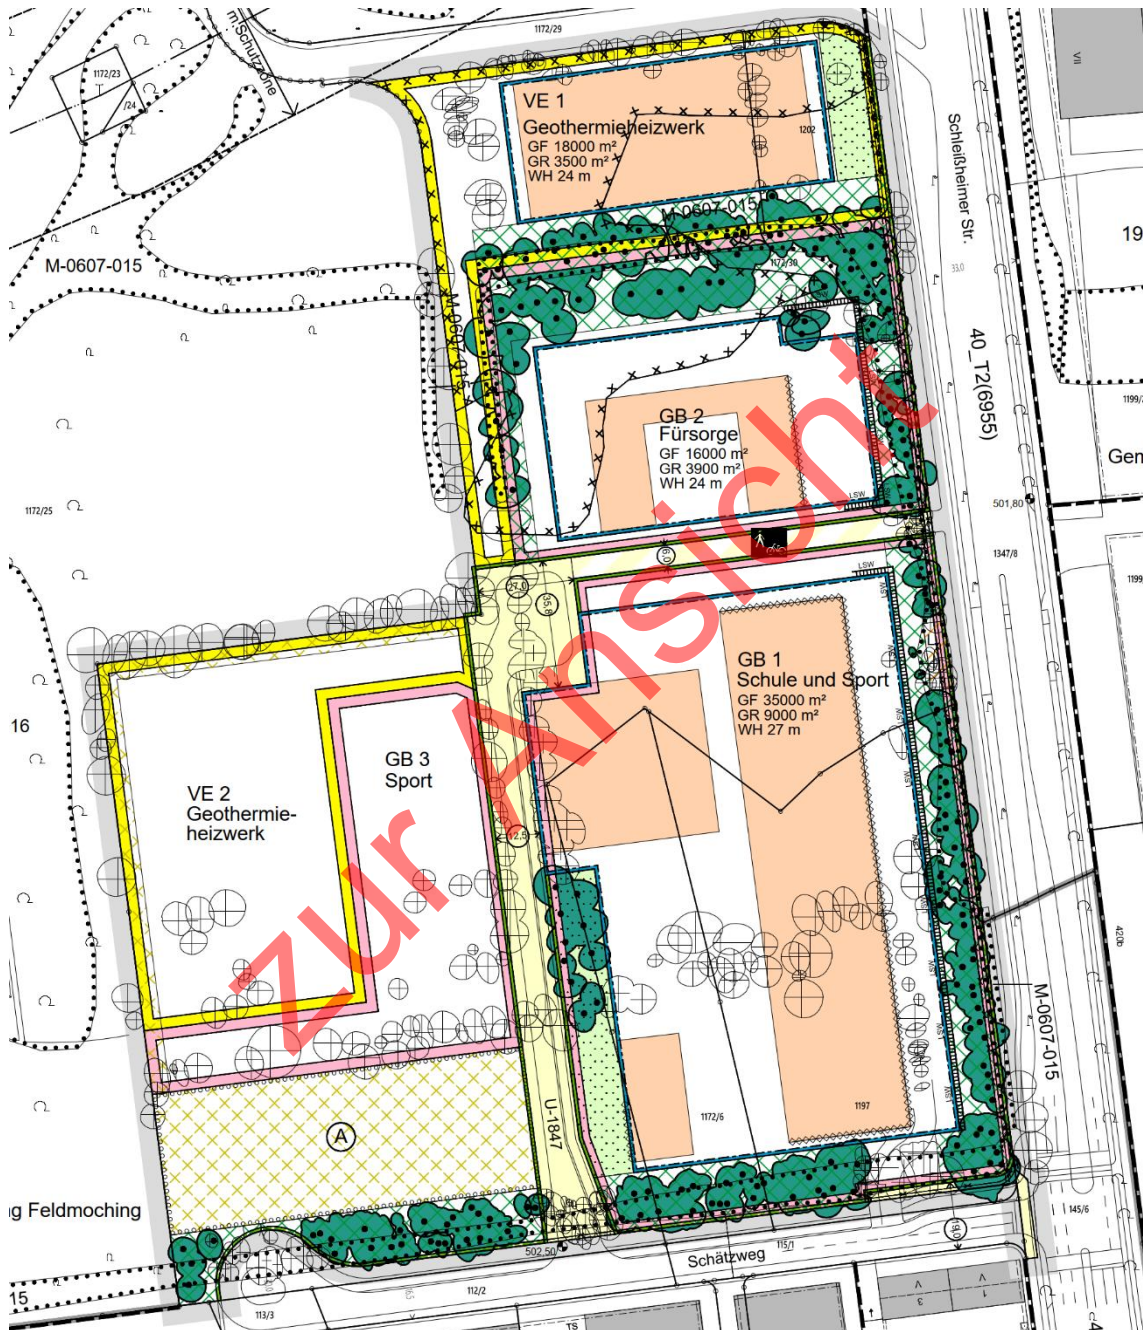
Auszug aus Bebauungsplan Nr. 1939e „Virginia-Depot“, Planstand 01/2025
